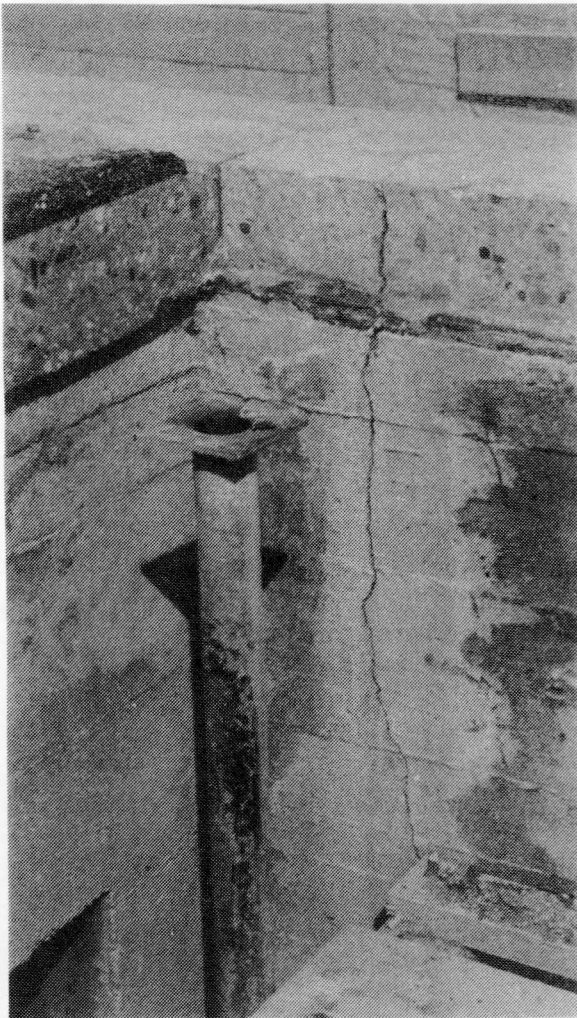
Riß in einem Stahlbetonrandunterzug im Strombrückenbereich
